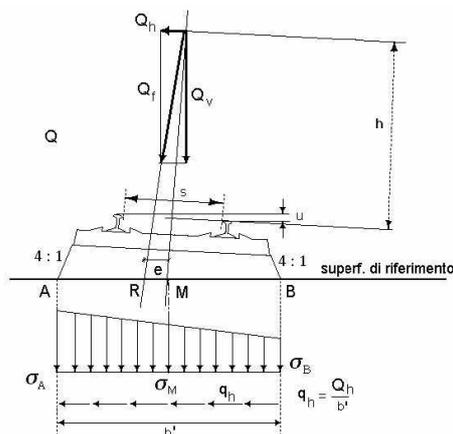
Distribuzione trasversale in curva delle azioni per mezzo delle traverse e del ballast. In figura, Q_h rappresenta la forza centrifuga definita al successivo §5.2.2.3.1
